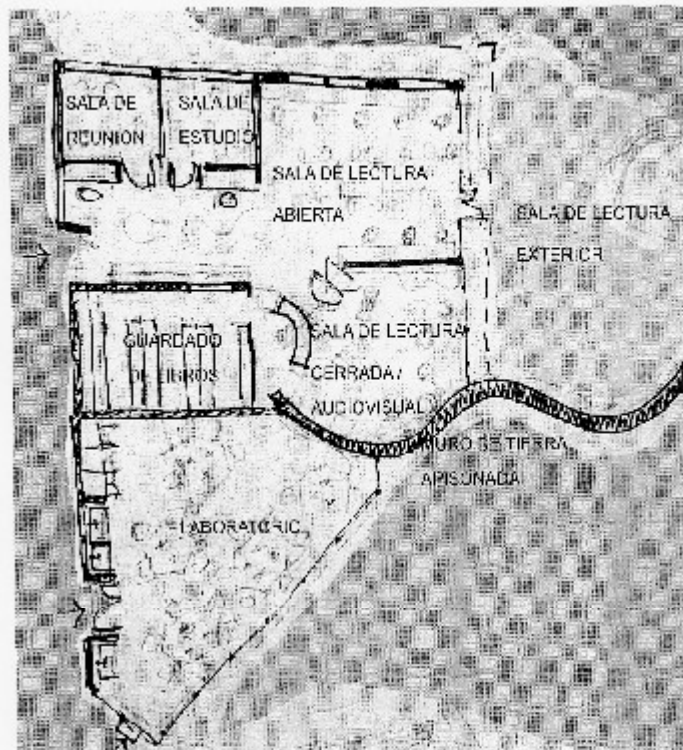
Cinqus Planta baja de Laboratorio y Centro Multimedial.
